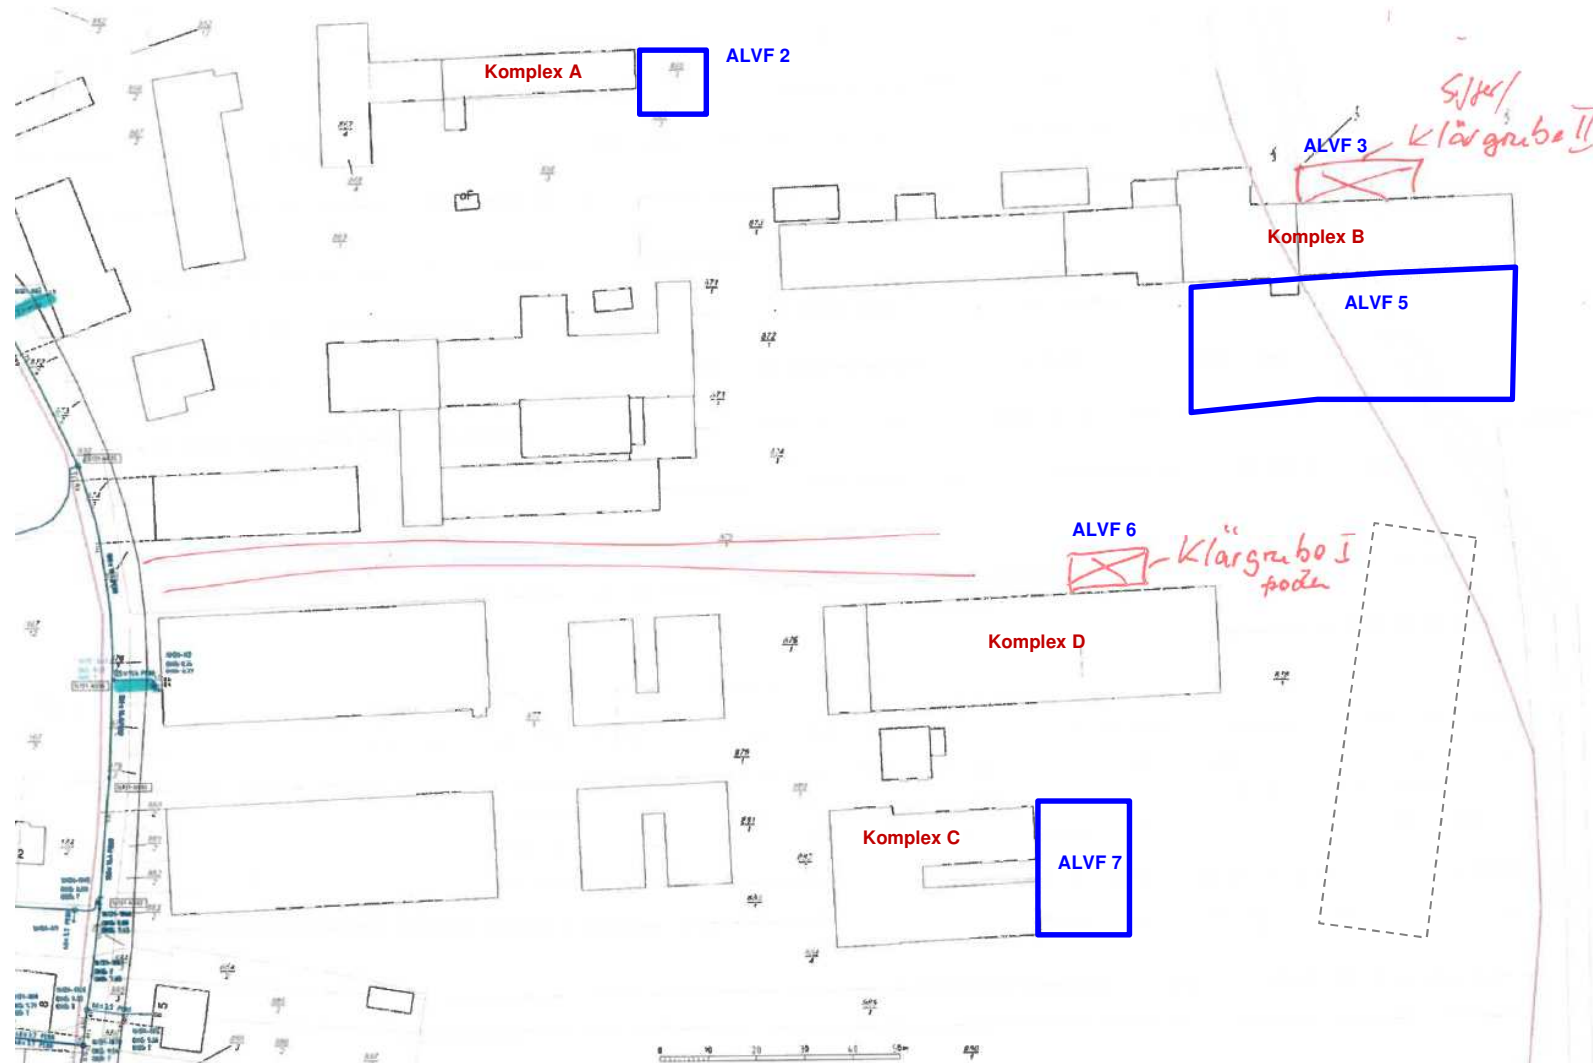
Auszug aus dem Leitungsplan zum Abwasser des WAZV Malchin-Stavenhagen mit ALVF-Flächen
